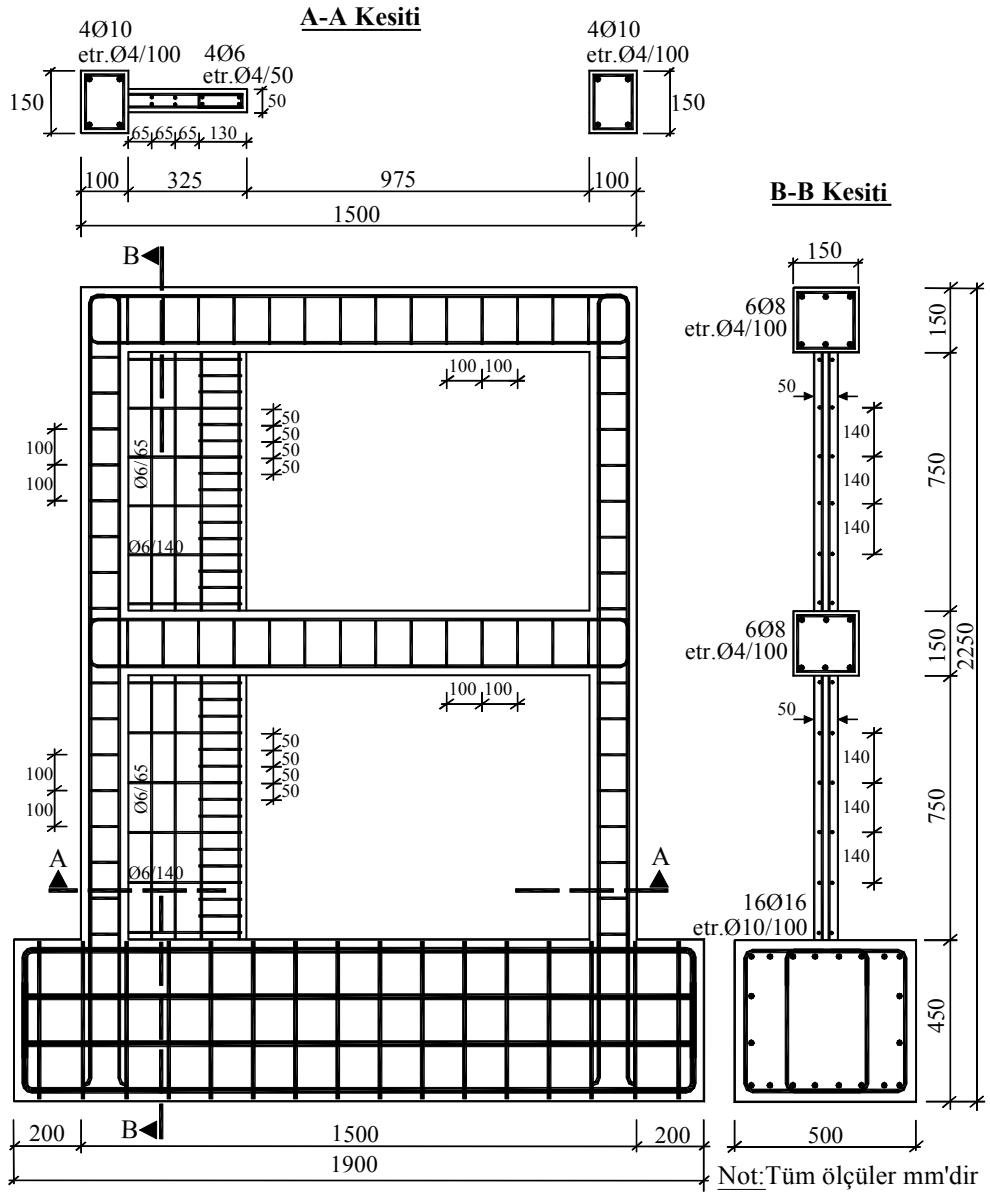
Deney Elemanı-2'nin donatı detayı
